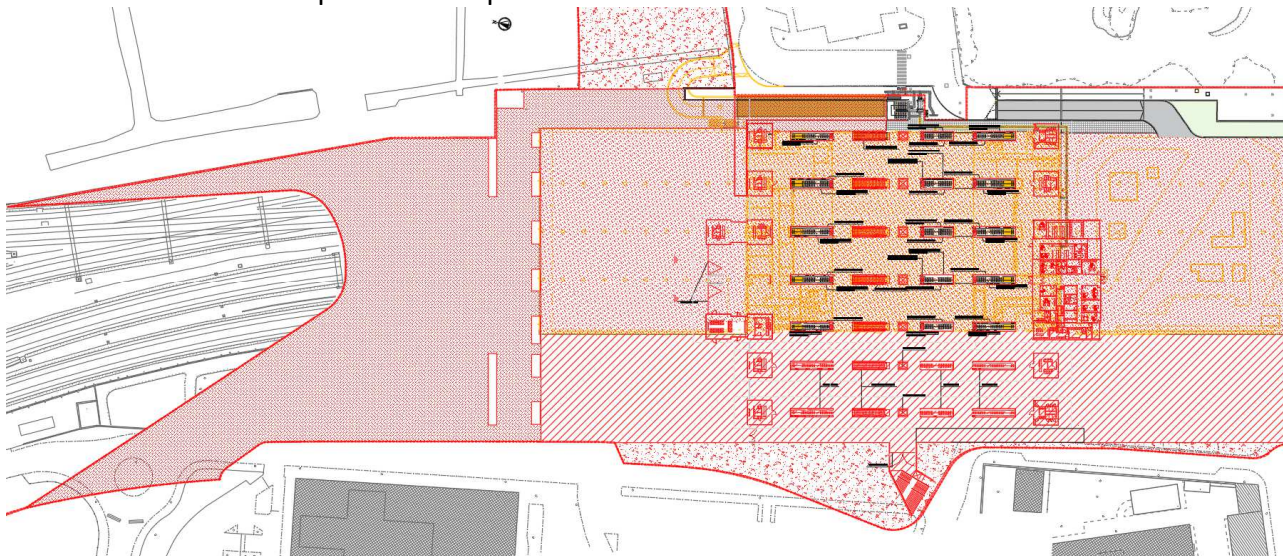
Planimetria demolizioni Piano Ingressi (demolizioni in giallo)
